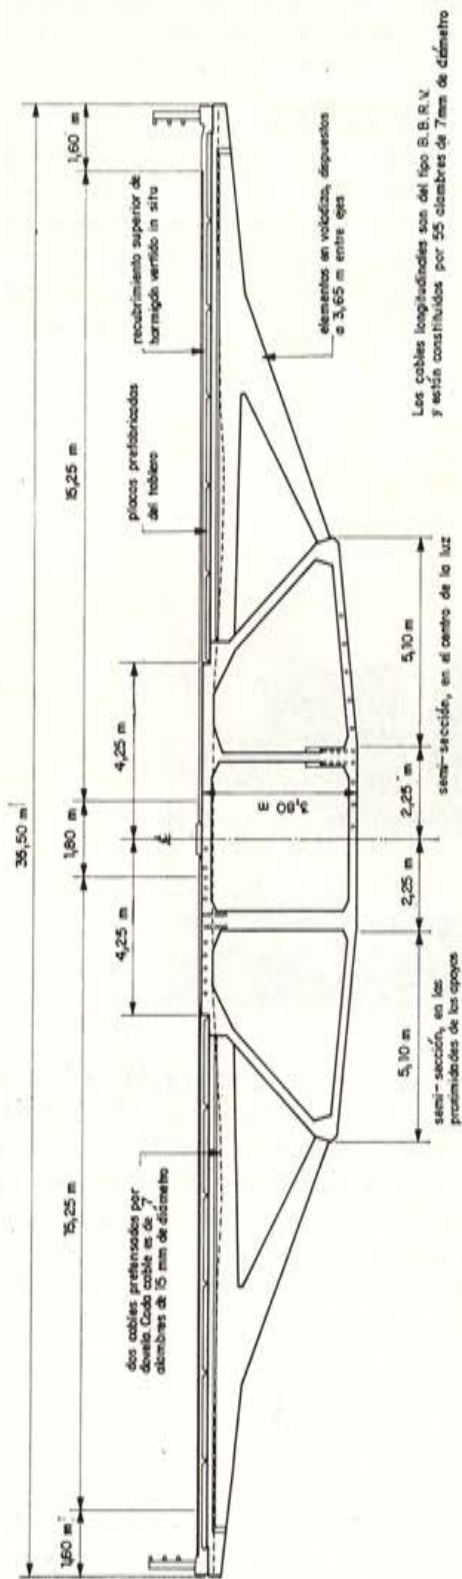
Viaducto de acceso al puente "West Gate". Sección transversal de la estructura del tablero.
